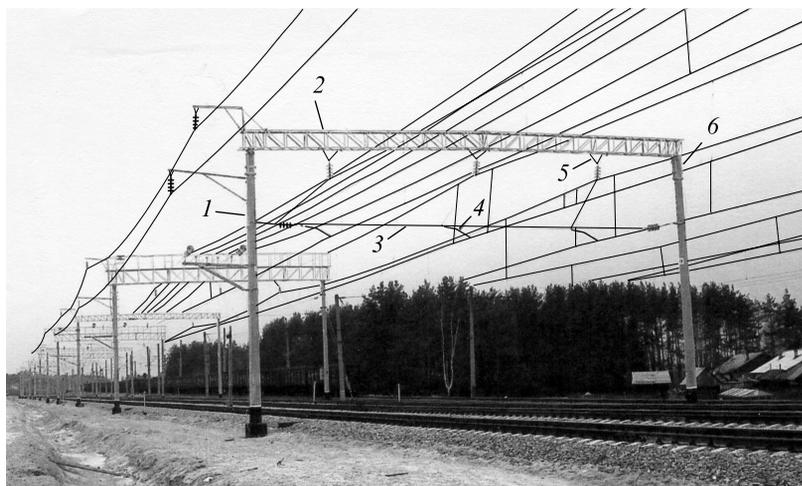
Жесткая поперечина: 1 — опора (стойка); 2 — жесткая поперечина (ригель); 3 — фиксирующий трос; 4 — фиксатор; 5 — треугольный подвес; 6 — оголовник
